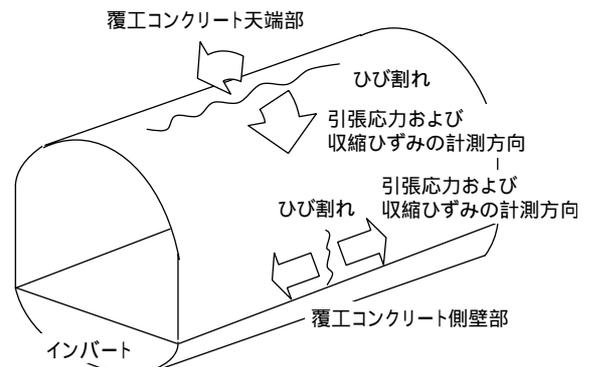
覆工コンクリートの一般的なひび割れパターン
